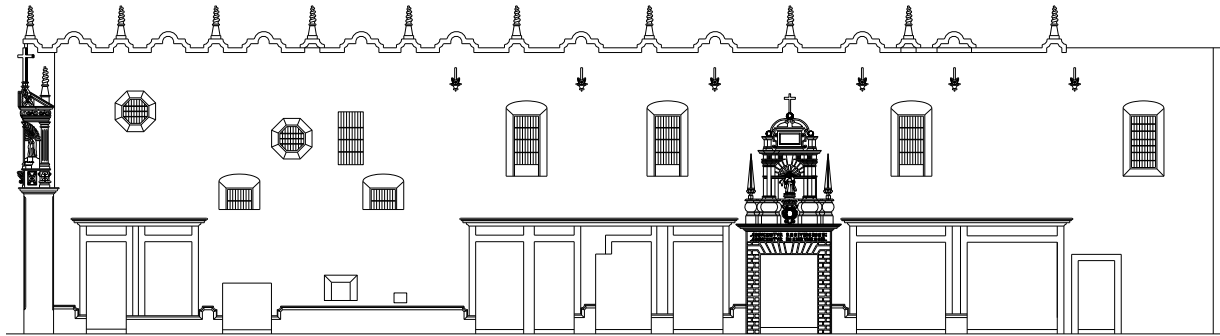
Plano de la fachada sur del Convento de Jesús María según el estado que guardó hasta el año 2000.
